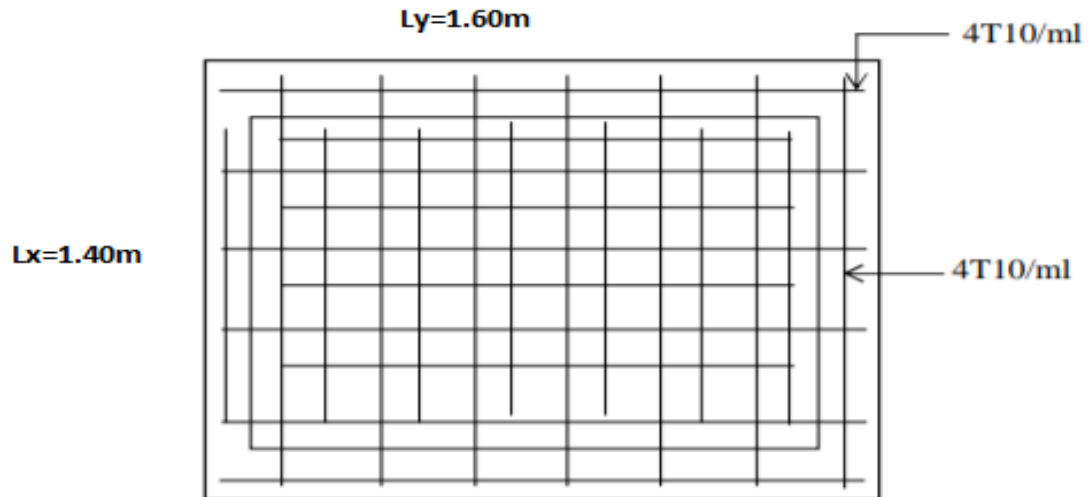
Ferrailage inférieure de la dalle de l'ascenseur.
